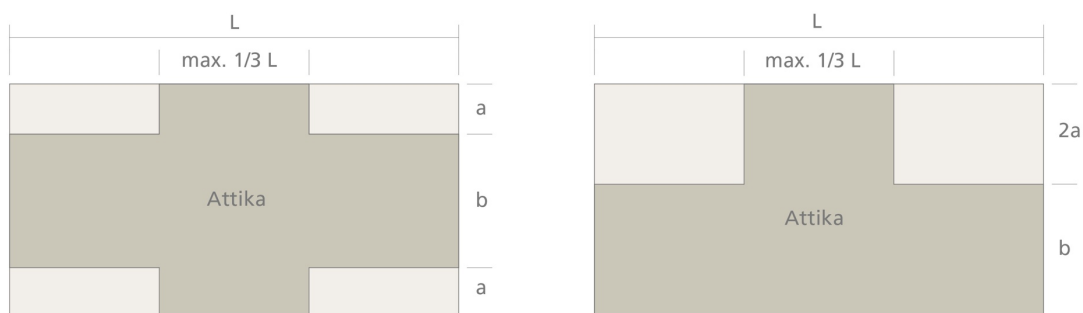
Schemaskizze Attikageschoss, links Regelfall, rechts an Fassade (Traufseite) geschoben
